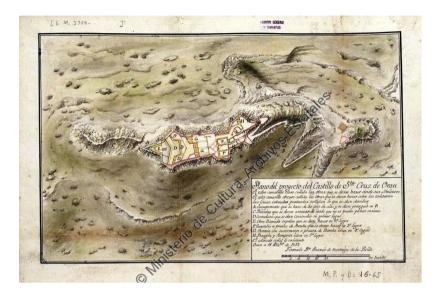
Planta del Castillo de Santa Cruz. Antonio de Monteagudo, 1732
